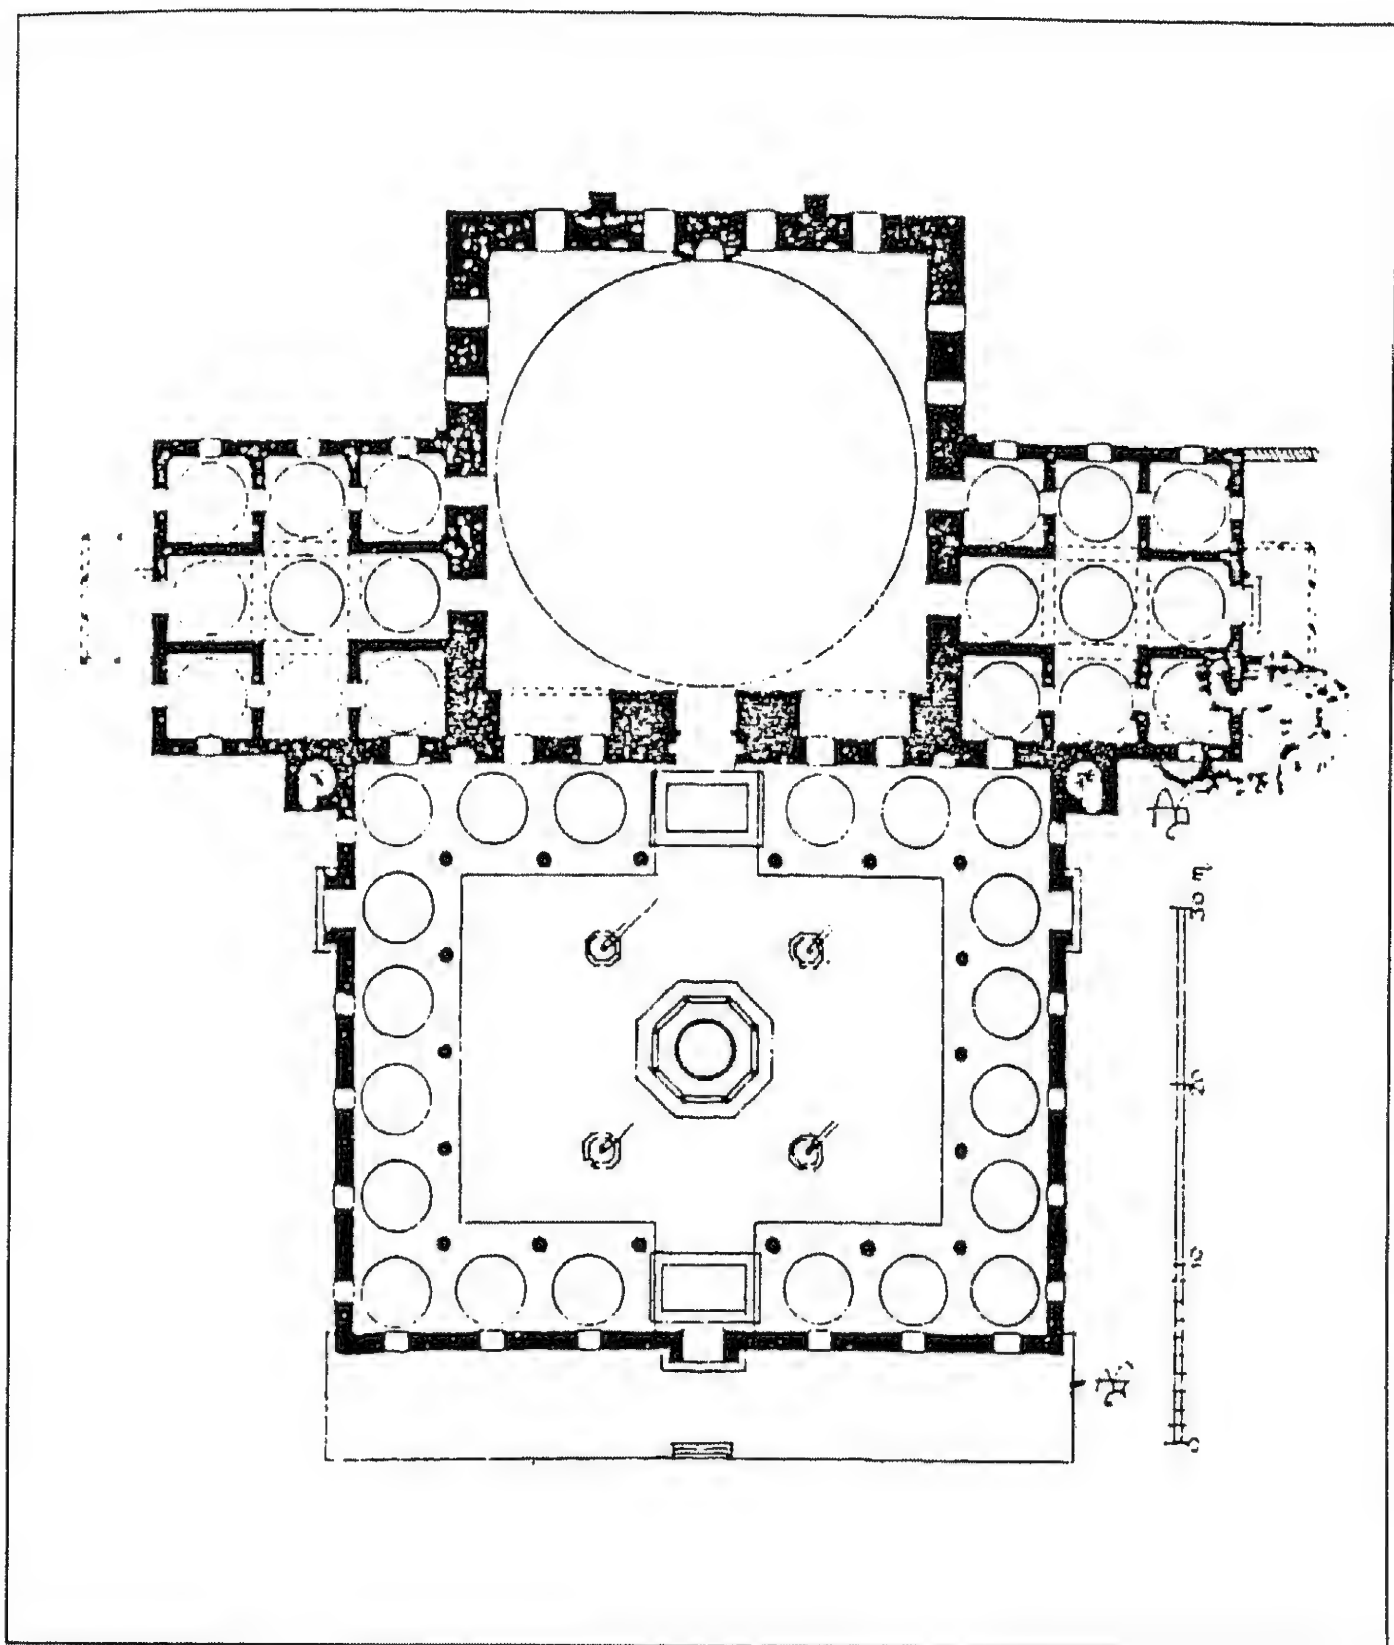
مسقط أفقي لمسجد الحنكار أو الحاكم في الباسان بالبانيا (عن : كيل) .
